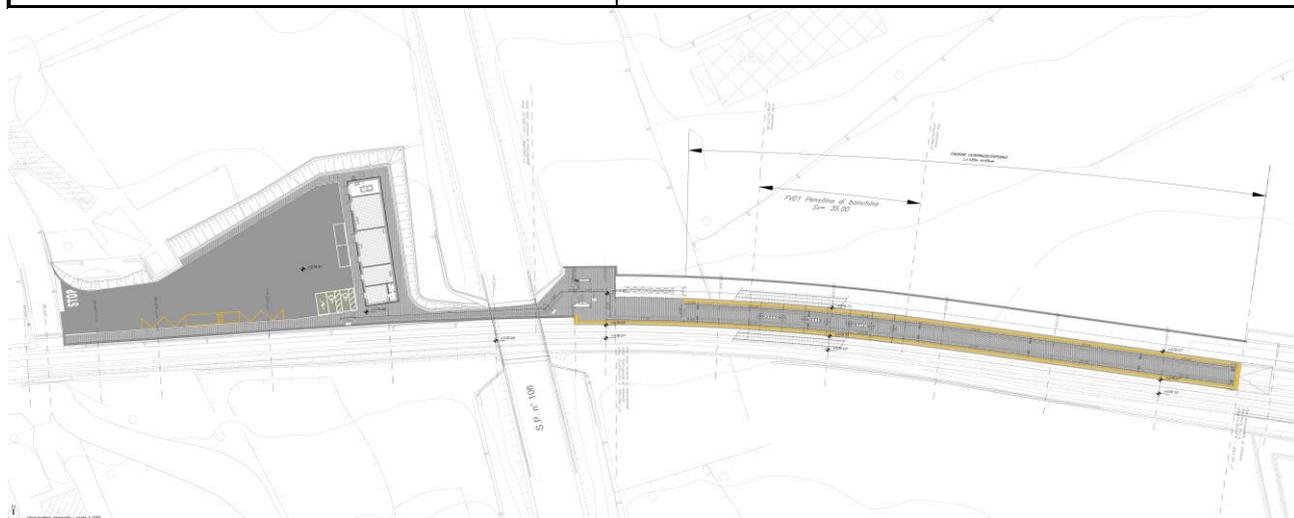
Planimetria banchina Stazione Cisternazzi
